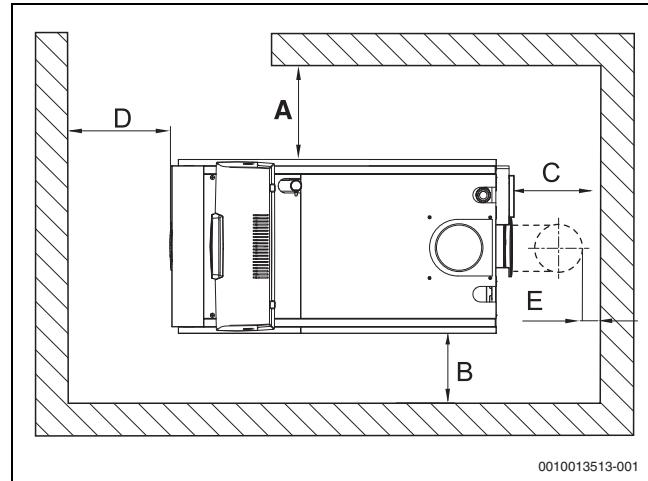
Wandabstände im Aufstellraum (Links-Ausführung)
